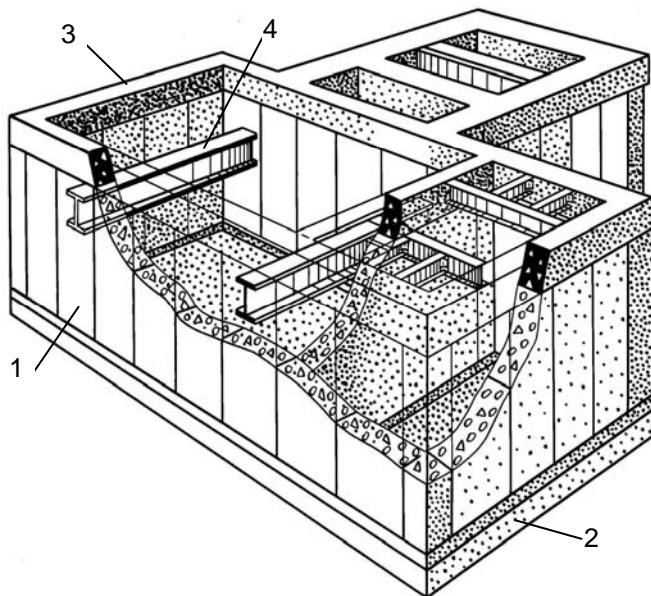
Збірний фундамент підйомної машини: 1 – залізобетонний блок, 2 – бетонна підготовка і нижній залізобетонний пояс, 3 – верхній залізобетонний пояс, 4 – опірні балки для підшипників барабана підйомної машини
